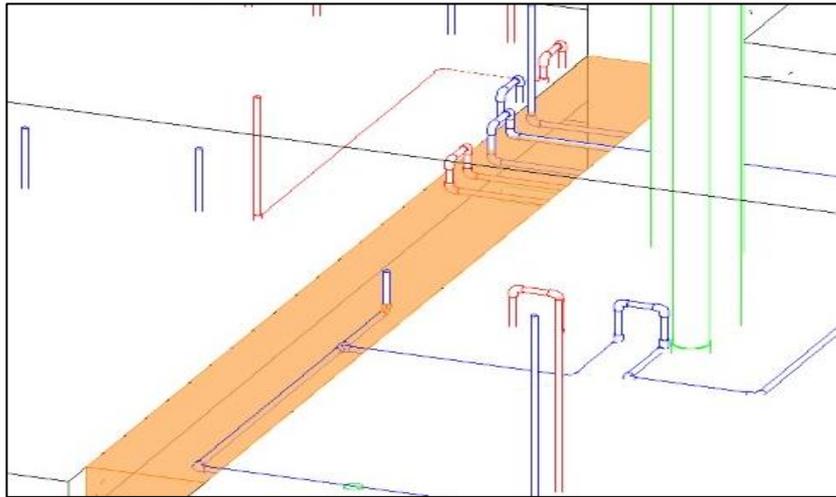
Interferencia de instalaciones sanitarias con estructuras – congestión de instalaciones en viga 2
